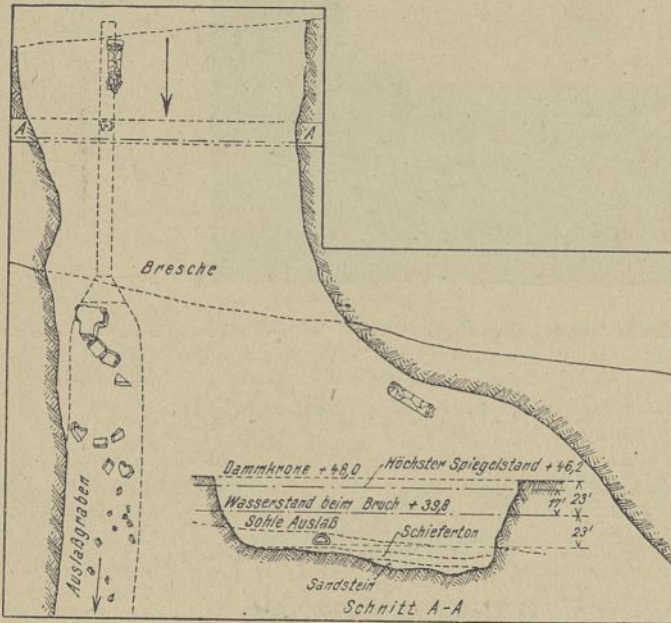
Grundriß der Bruchstelle und Längenschnitt.
